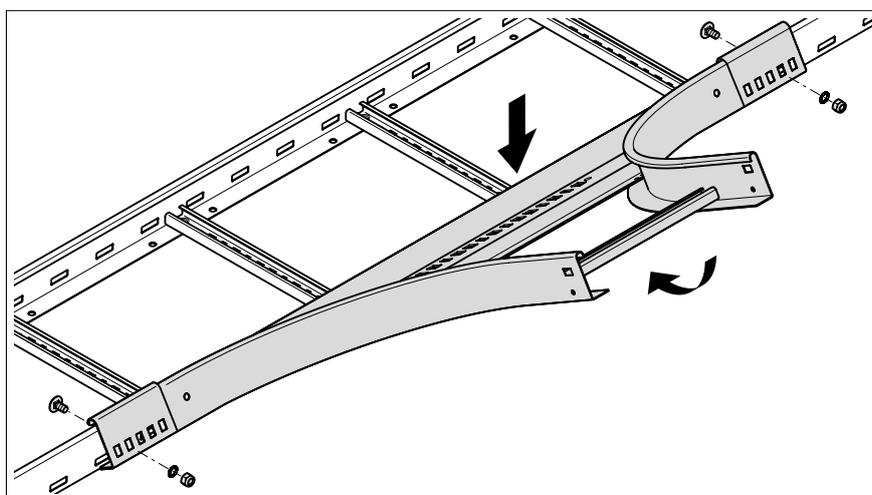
Установка Т-образного/крестового соединения в кабельный лоток лестничного типа
